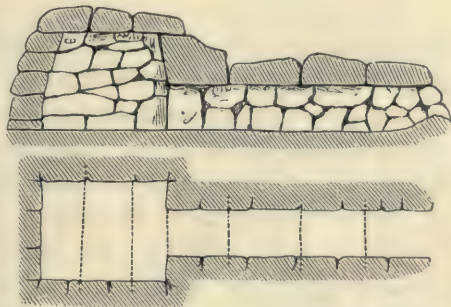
a u. b. Ganggrab. Grundriss und Durchschnitt. Japan<sup>2</sup>.
